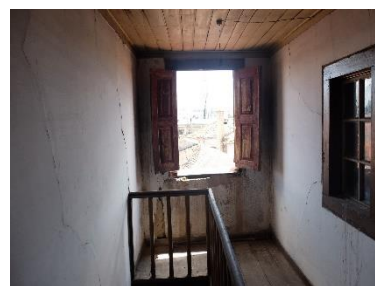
Janela do sótão já sem caixilharia e portada em estado avançado de degradação
